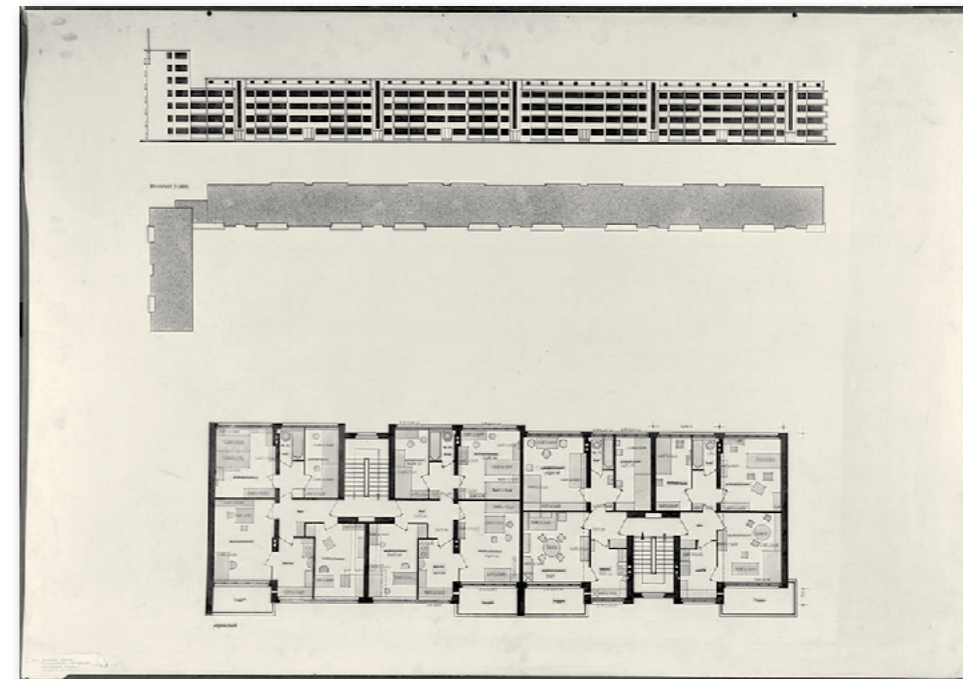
Walter Gropius. Proyecto de viviendas para la Siemensstadt (1930)
